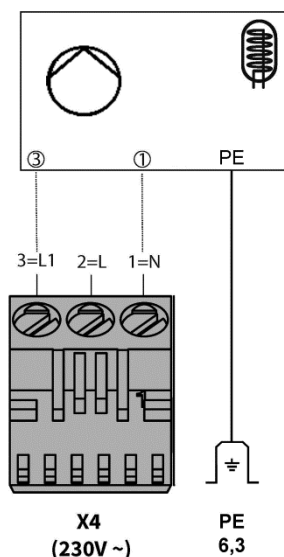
Anschluss Ladepumpe für Trinkwarmwasserspeicher
